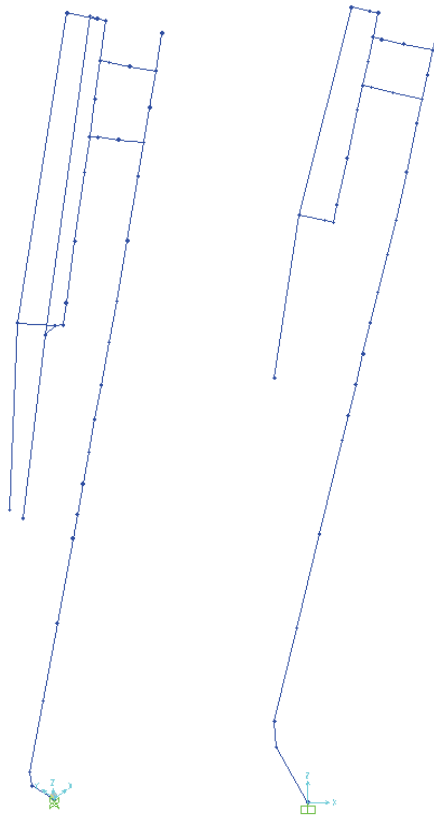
Vista laterale e vista assonometrica del modello a tutta altezza.
